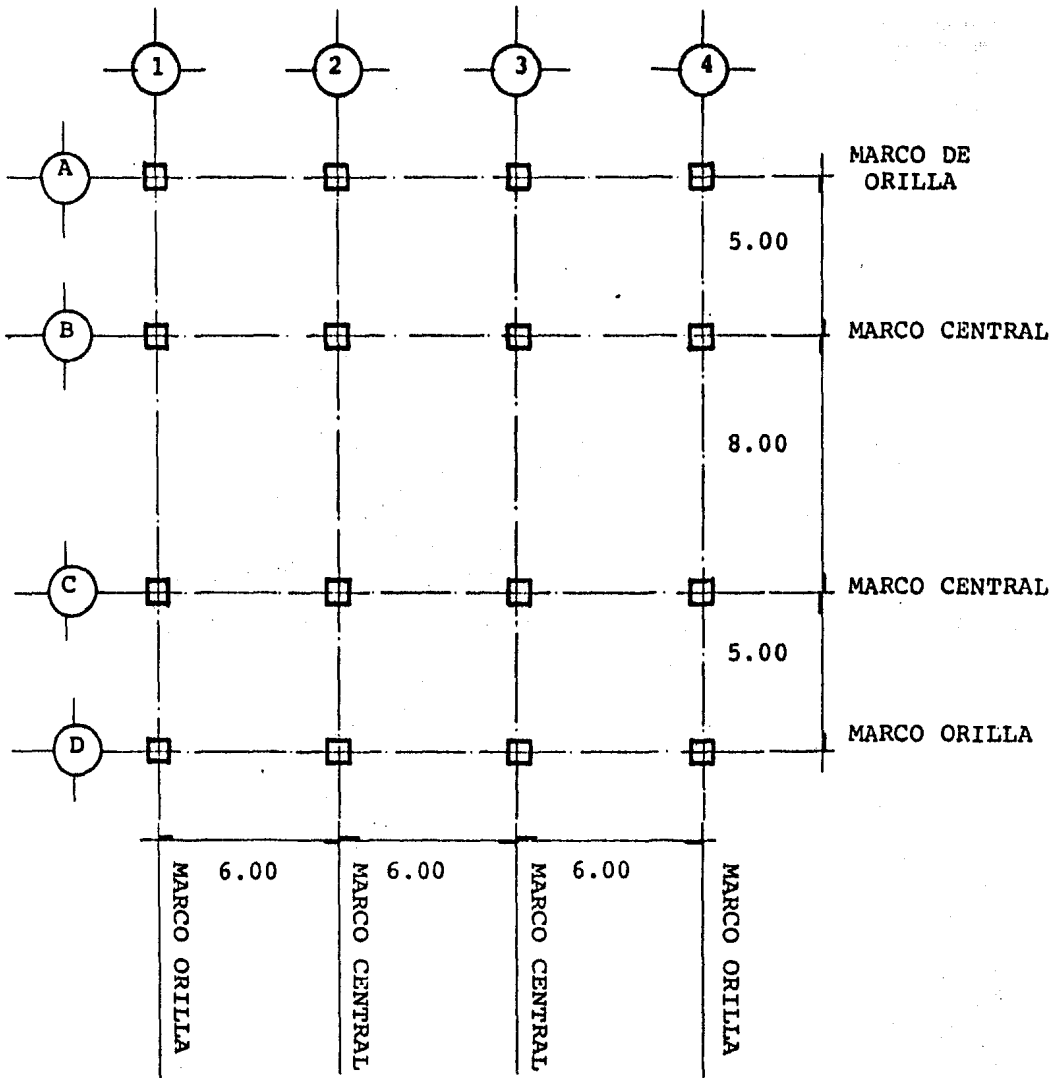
PLANTA DE UBICACION DE COLUMNAS
